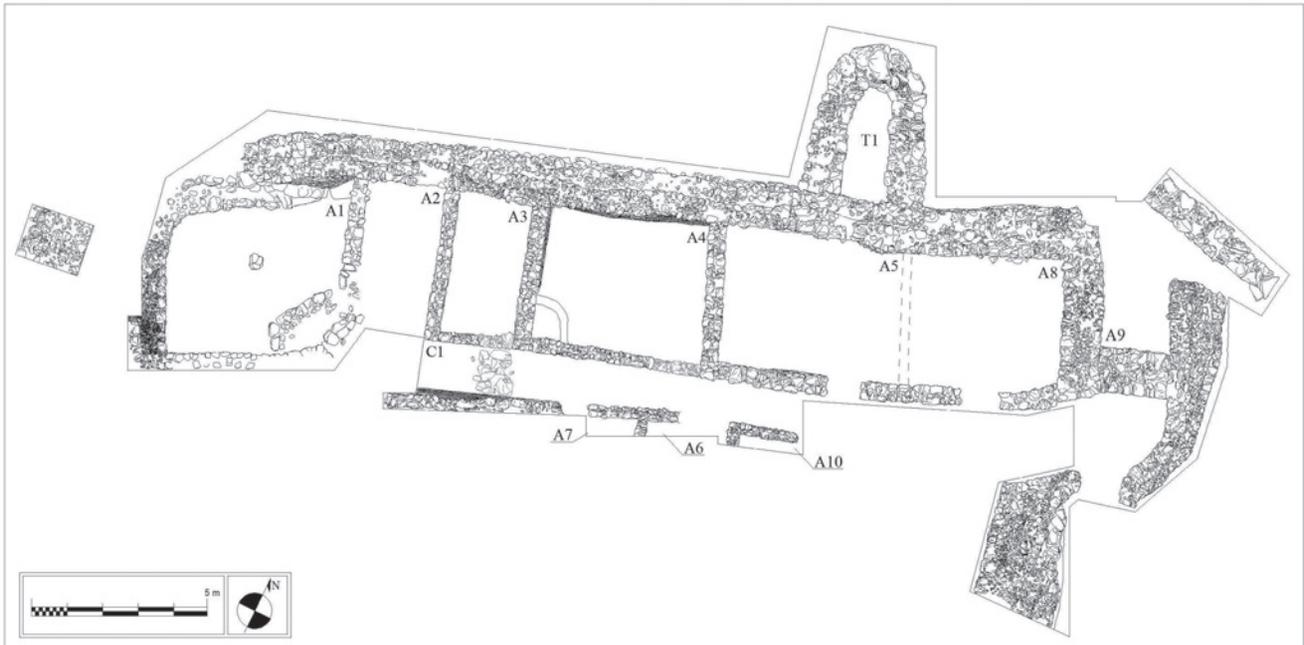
Planimetría del Barrio Norte de Sant Jaume-Mas d'en Serrà.
